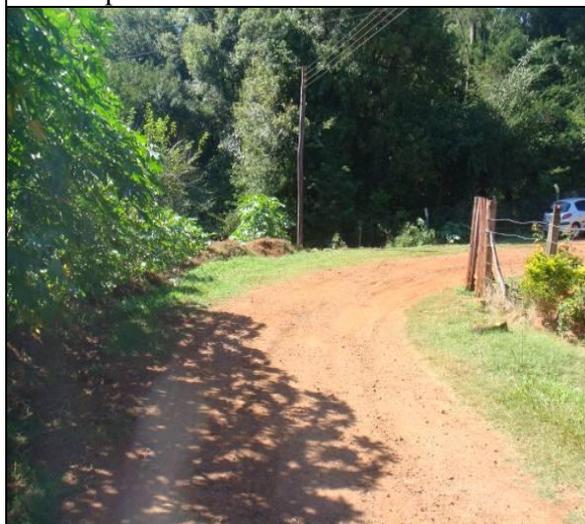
Fossa existente (enterrada) e futura EBE, à esquerda, na zona baixa da cidade.
